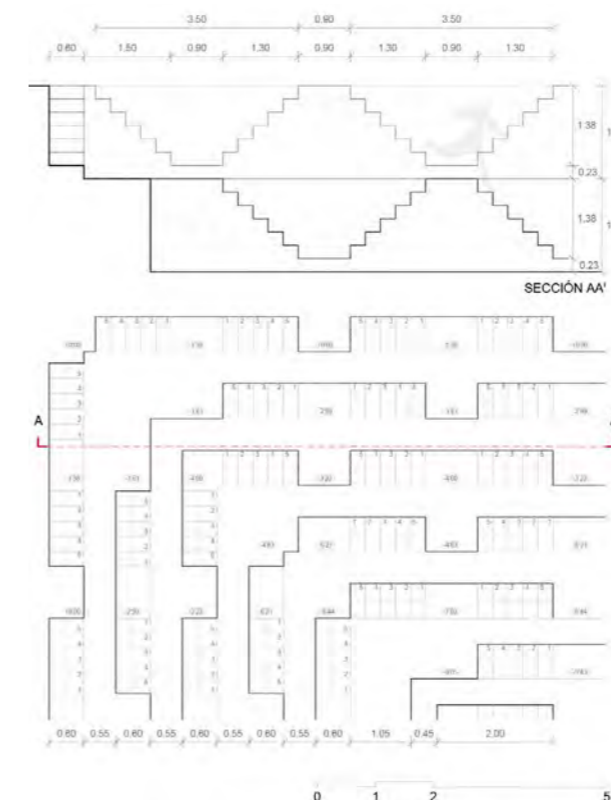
Detalle en planta y sección del escalonado de Chand Baori. Dibujado con medidas tomadas in situ. © Elaboración de Inés Downing y del propio autor.
